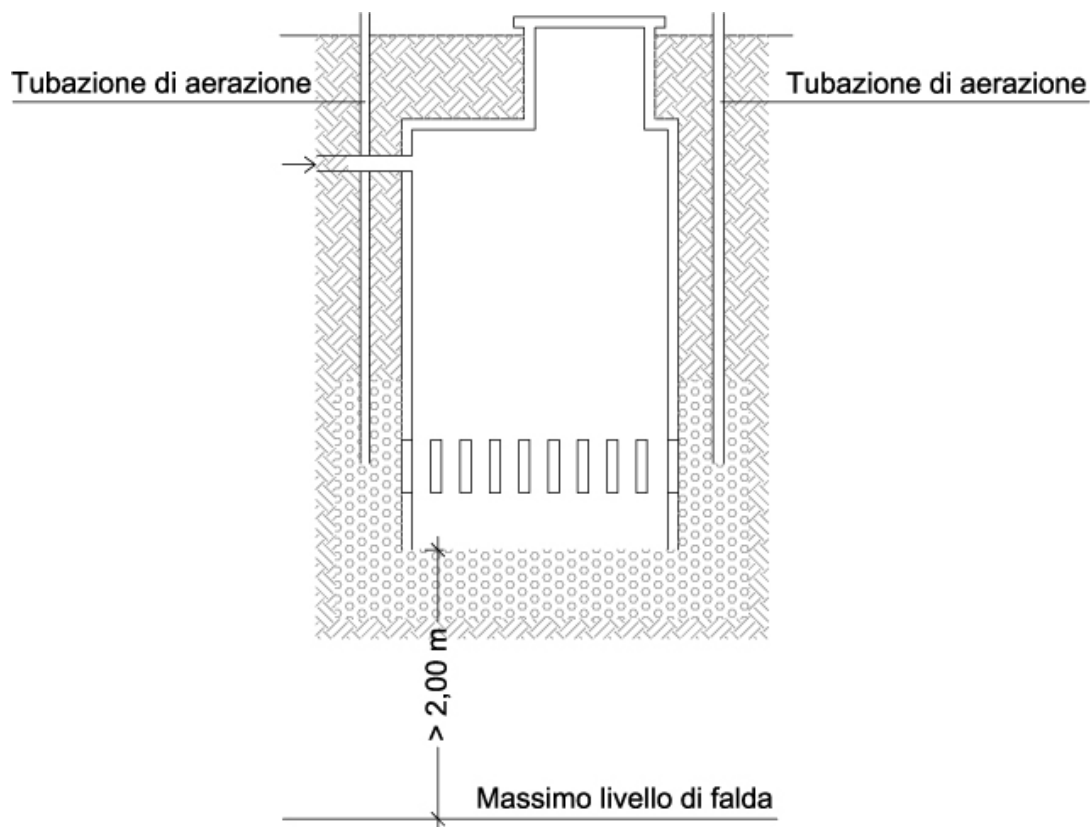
Schema sezione longitudinale pozzo assorbente
